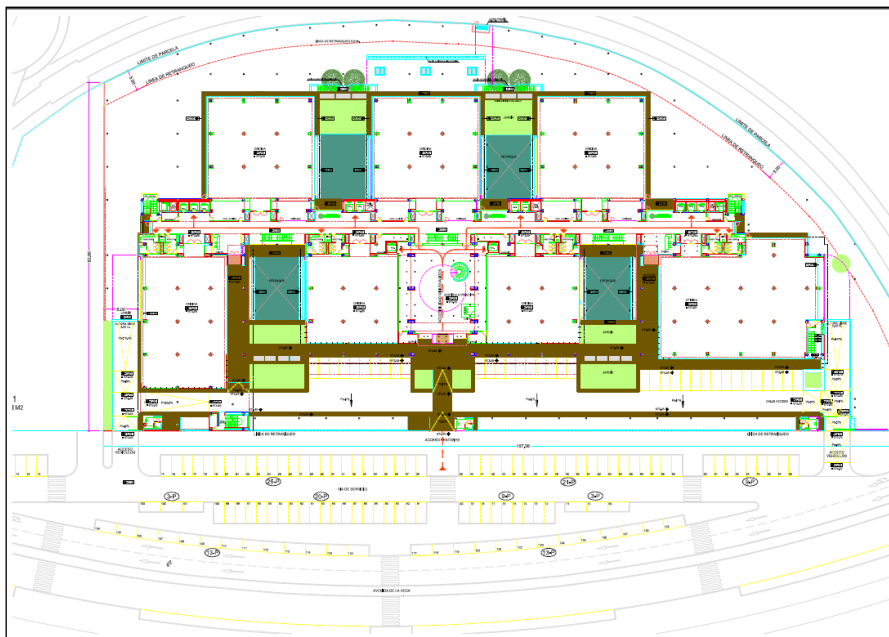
Plano de las instalaciones del centro de Arroyo de la Vega (Madrid)
